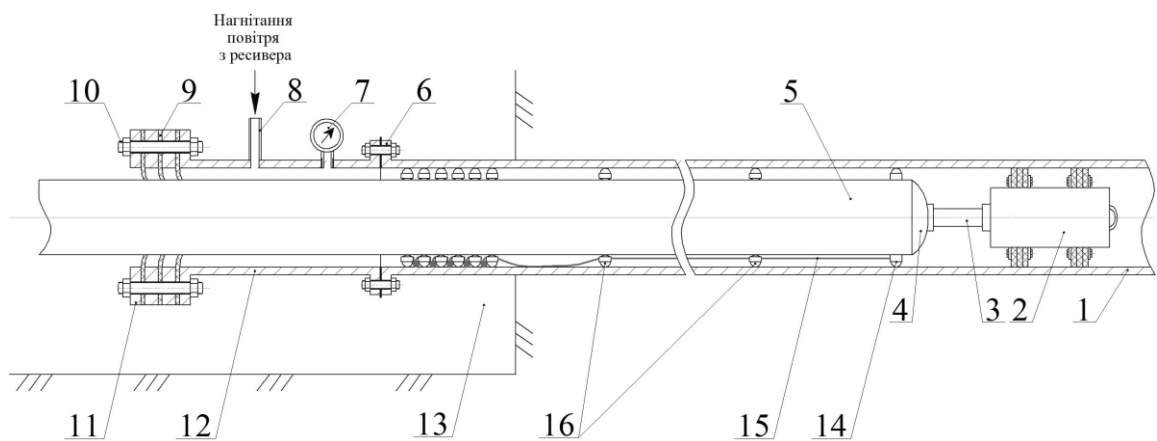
Конструкція пристрою для протягування поршнем нового поліетиленового трубопроводу в зношений сталевий з використанням опорно-центруючих кілець
